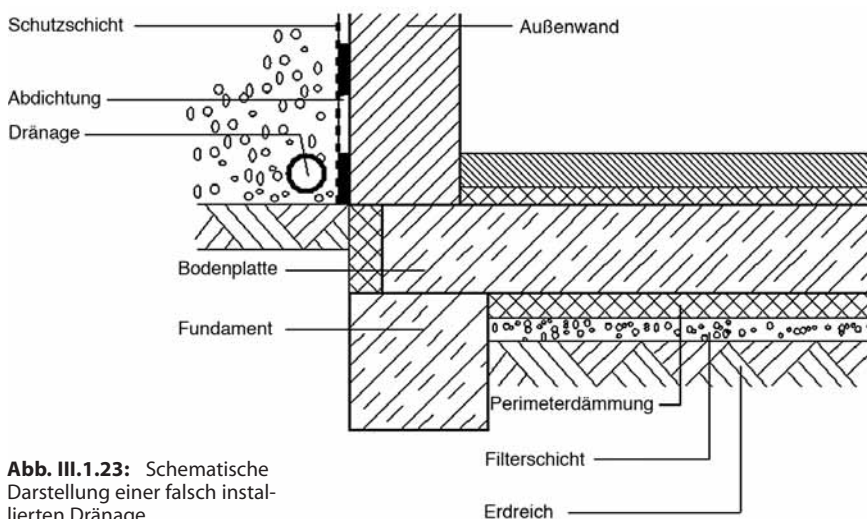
Schematische Darstellung einer falsch installierten Drainage
